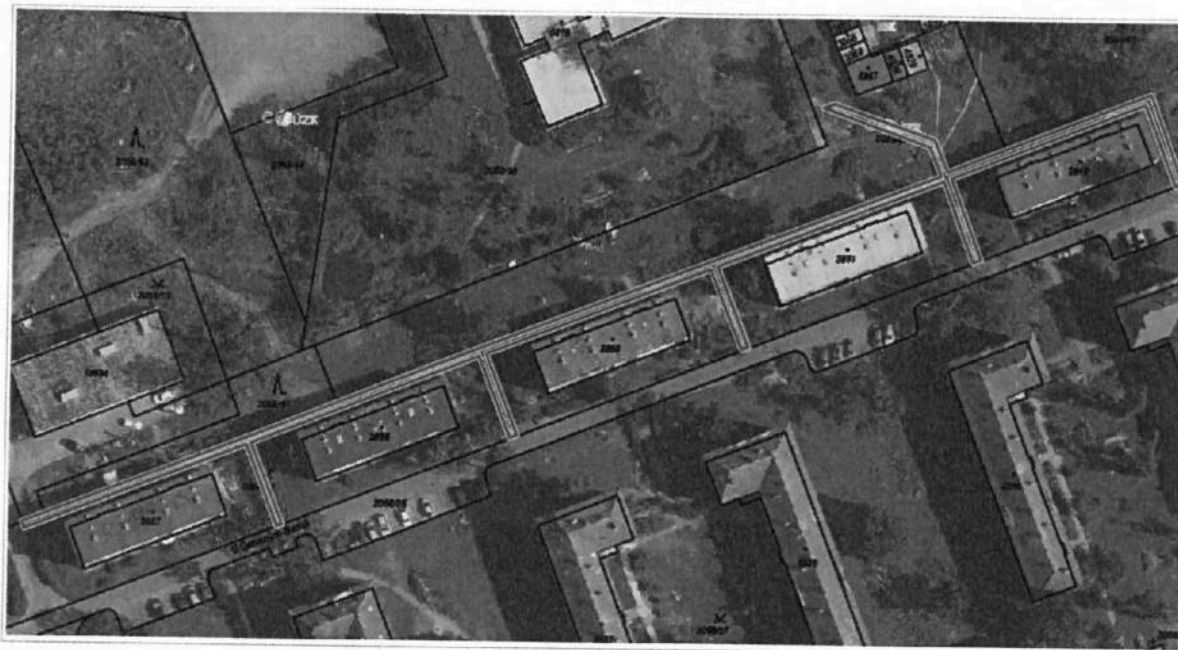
část 1) Prostory kolem bytových domů na ul. U Červených domků
